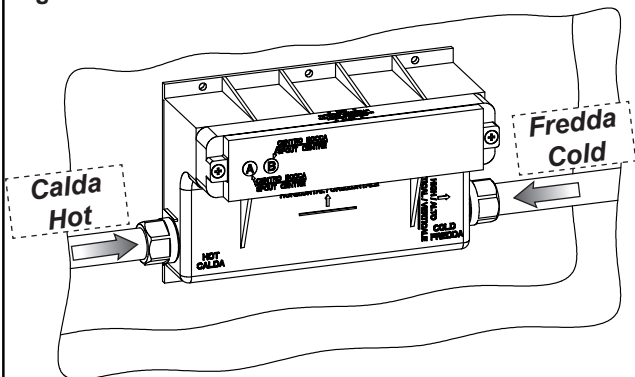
Для изготовления правильного проема под встроенный корпус необходимо проверить его реальные габаритные размеры и учесть минимальную и максимальную глубину встраивания, указанную на пластиковой защите, установленной на корпус.
